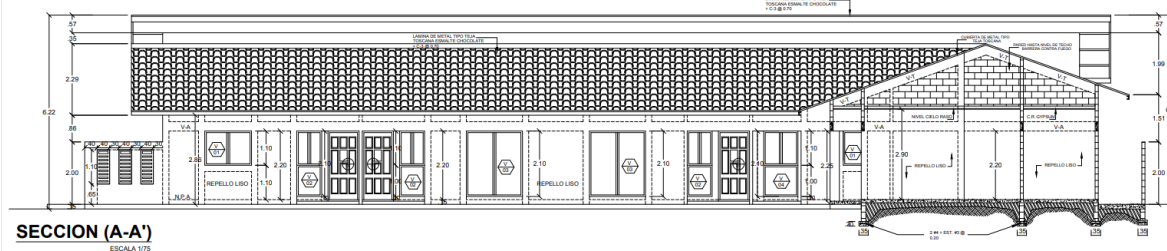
Sección (A-A'). Fuente: plano de anteproyecto
